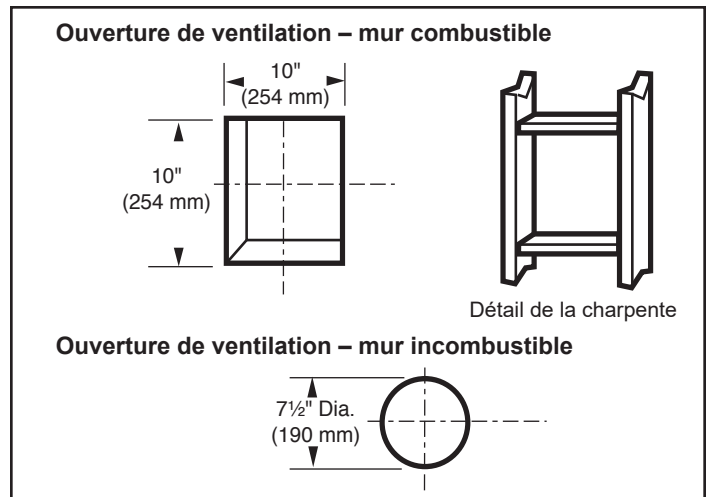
Localiser l'ouverture de la ventilation sur le mur
